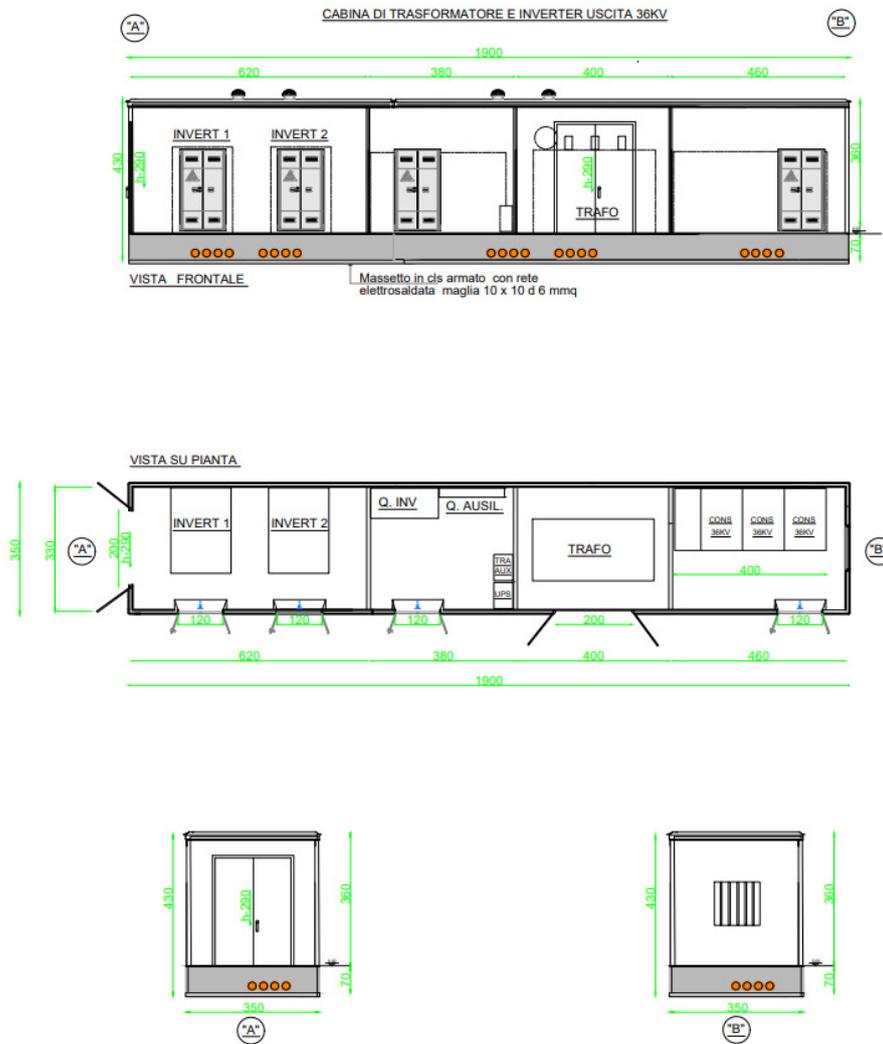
Planimetria e prospetti dell'unità di trasformazione tipo.
